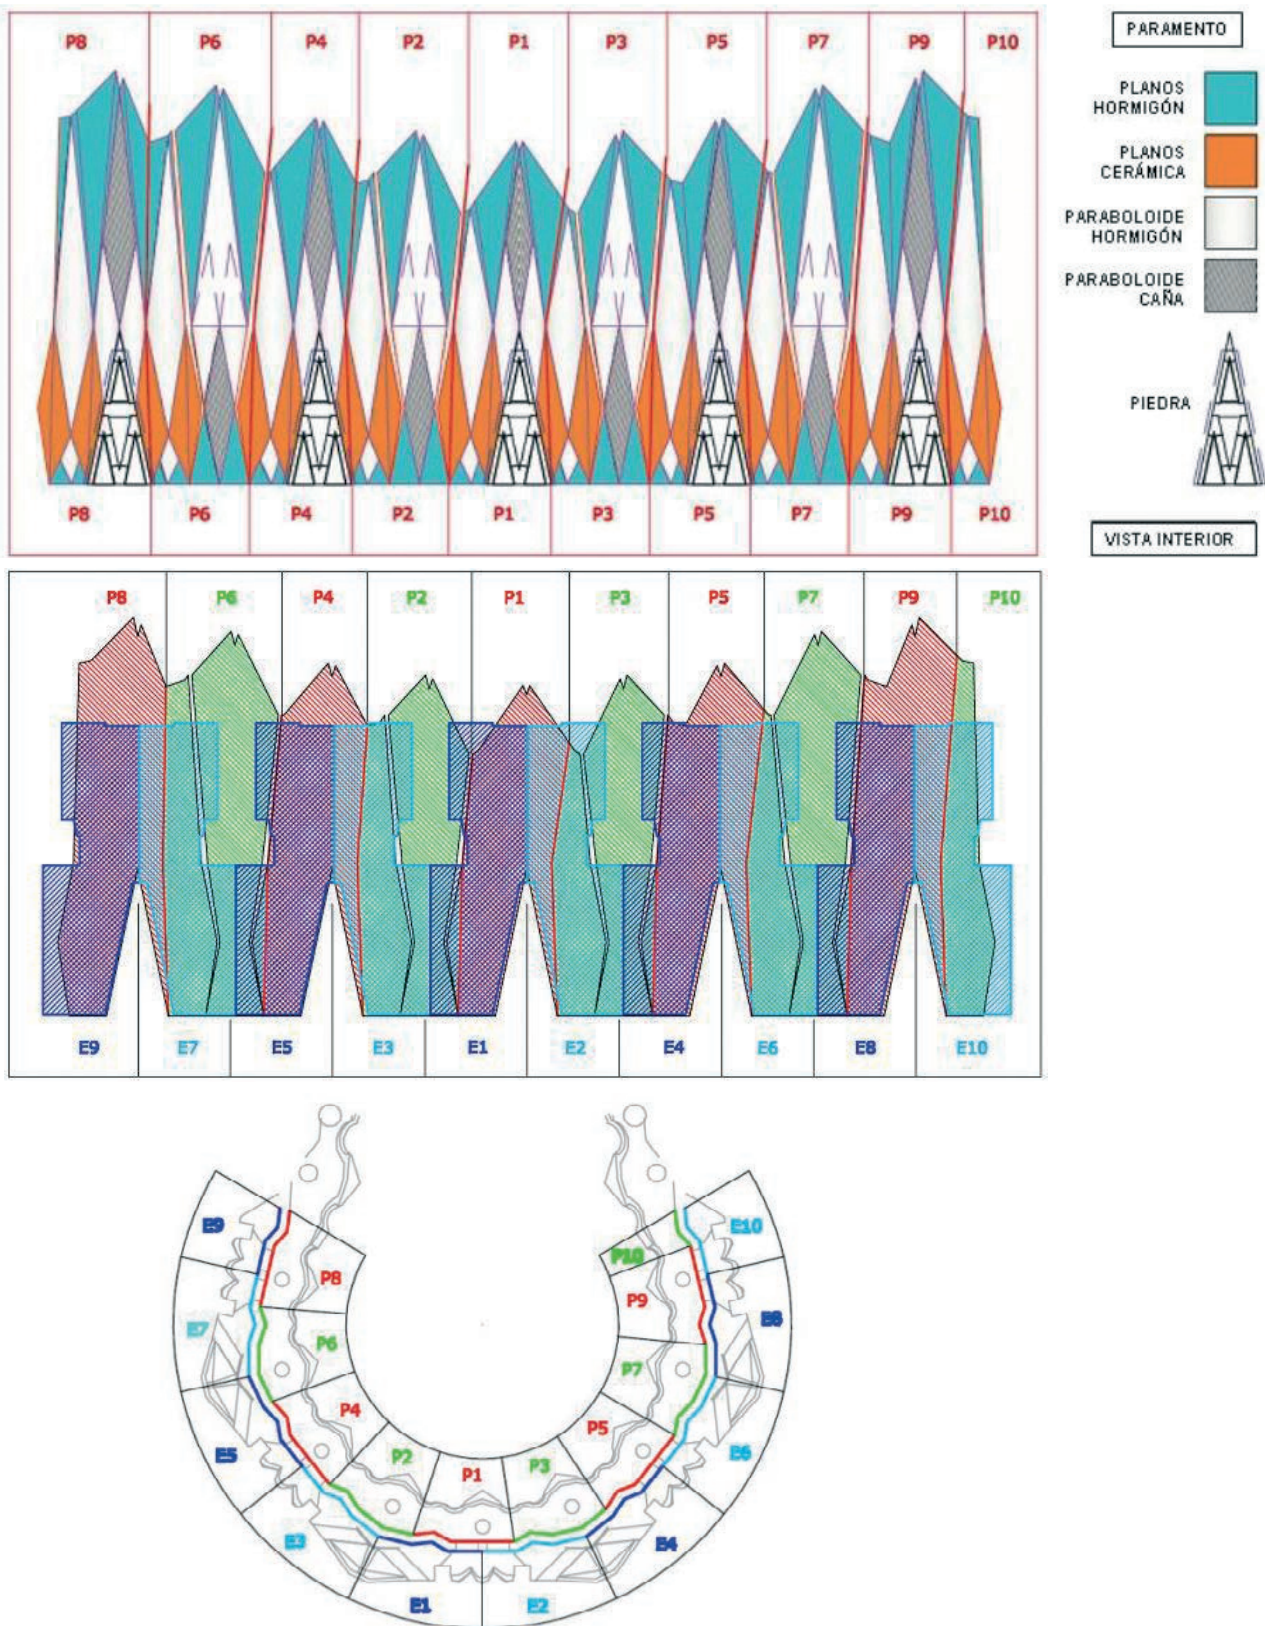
a) Alzado del encofrado interior, b) alzado del encofrado exterior e interior y c) planta de los encofrados. Fuente: ATESF
